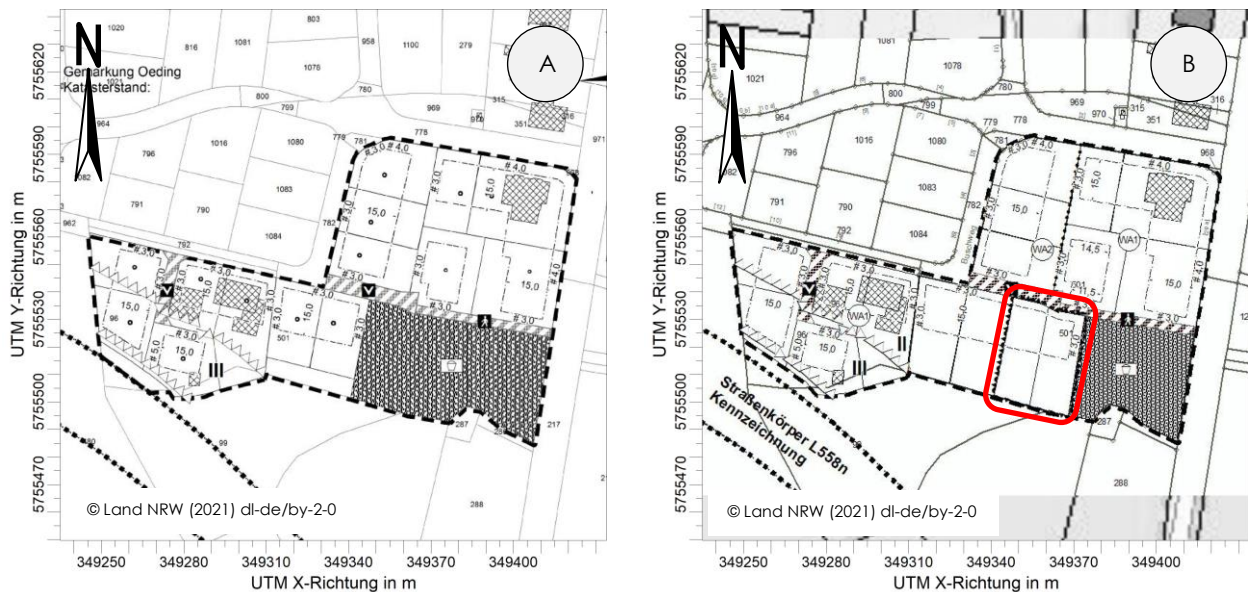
Planungskonzepte des Bebauungsplanes Nr. 58 "Buschweg/Burloer Straße"; Bild (A): Planzeichnung gemäß Bebauungsplan-Entwurf Stand 08/2020, Bild (B): Planzeichnung Stand 08/2021
